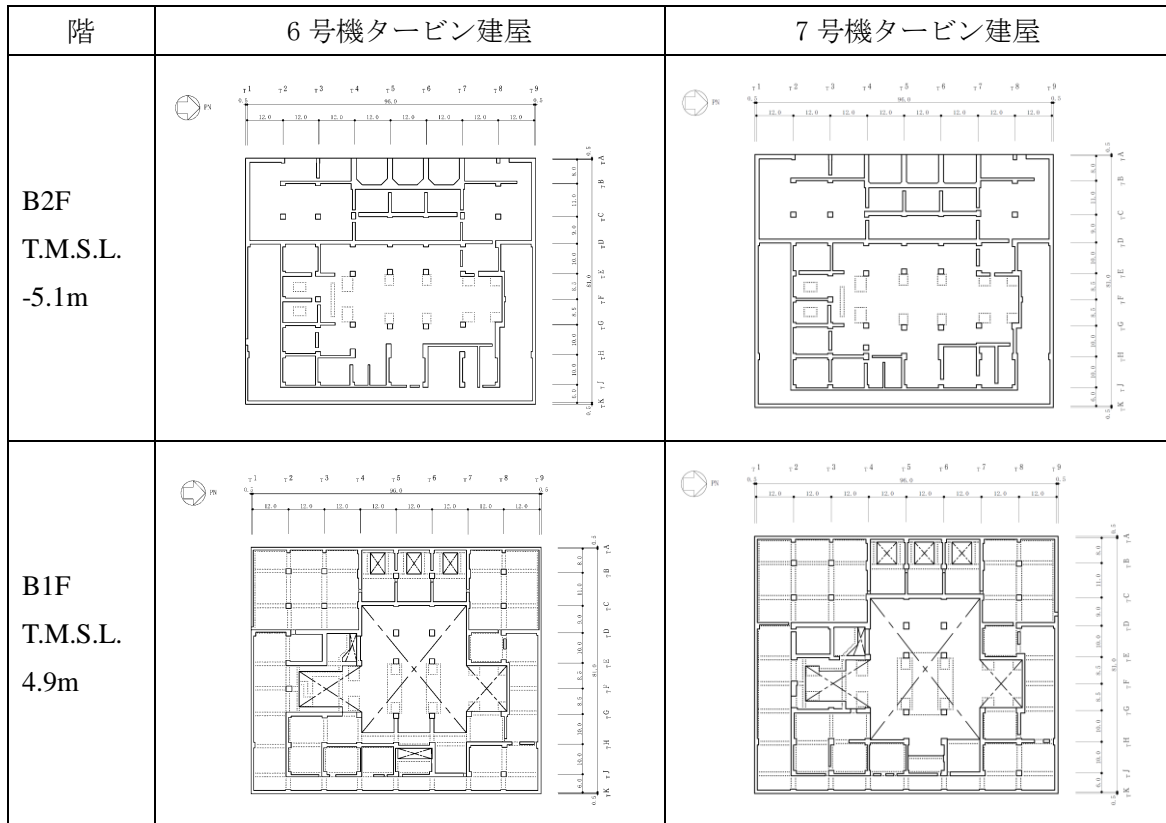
6号機タービン建屋及び7号機タービン建屋の概略平面図 (2/2) (単位: m)
